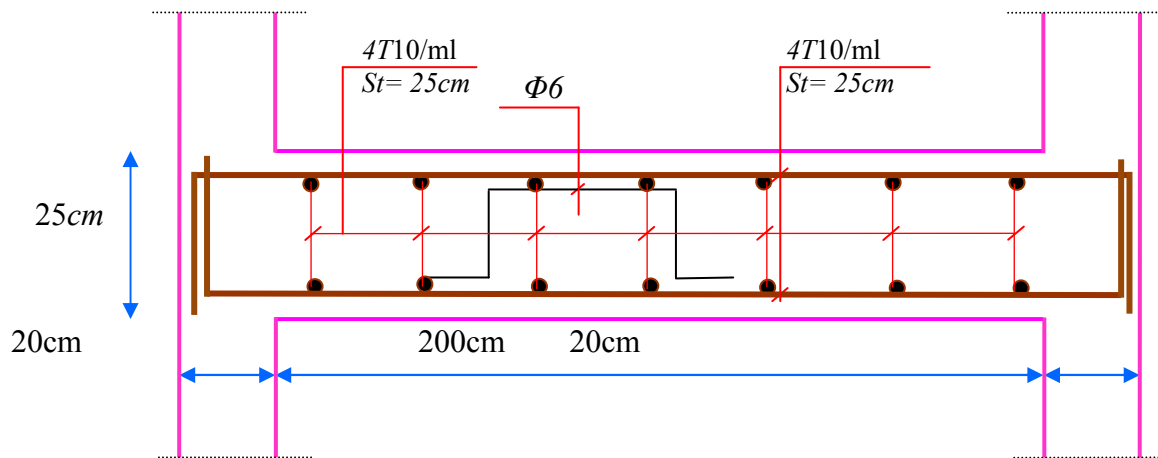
SCHEMA DE FERRAILAGE DE LA DALLE MACHINE
